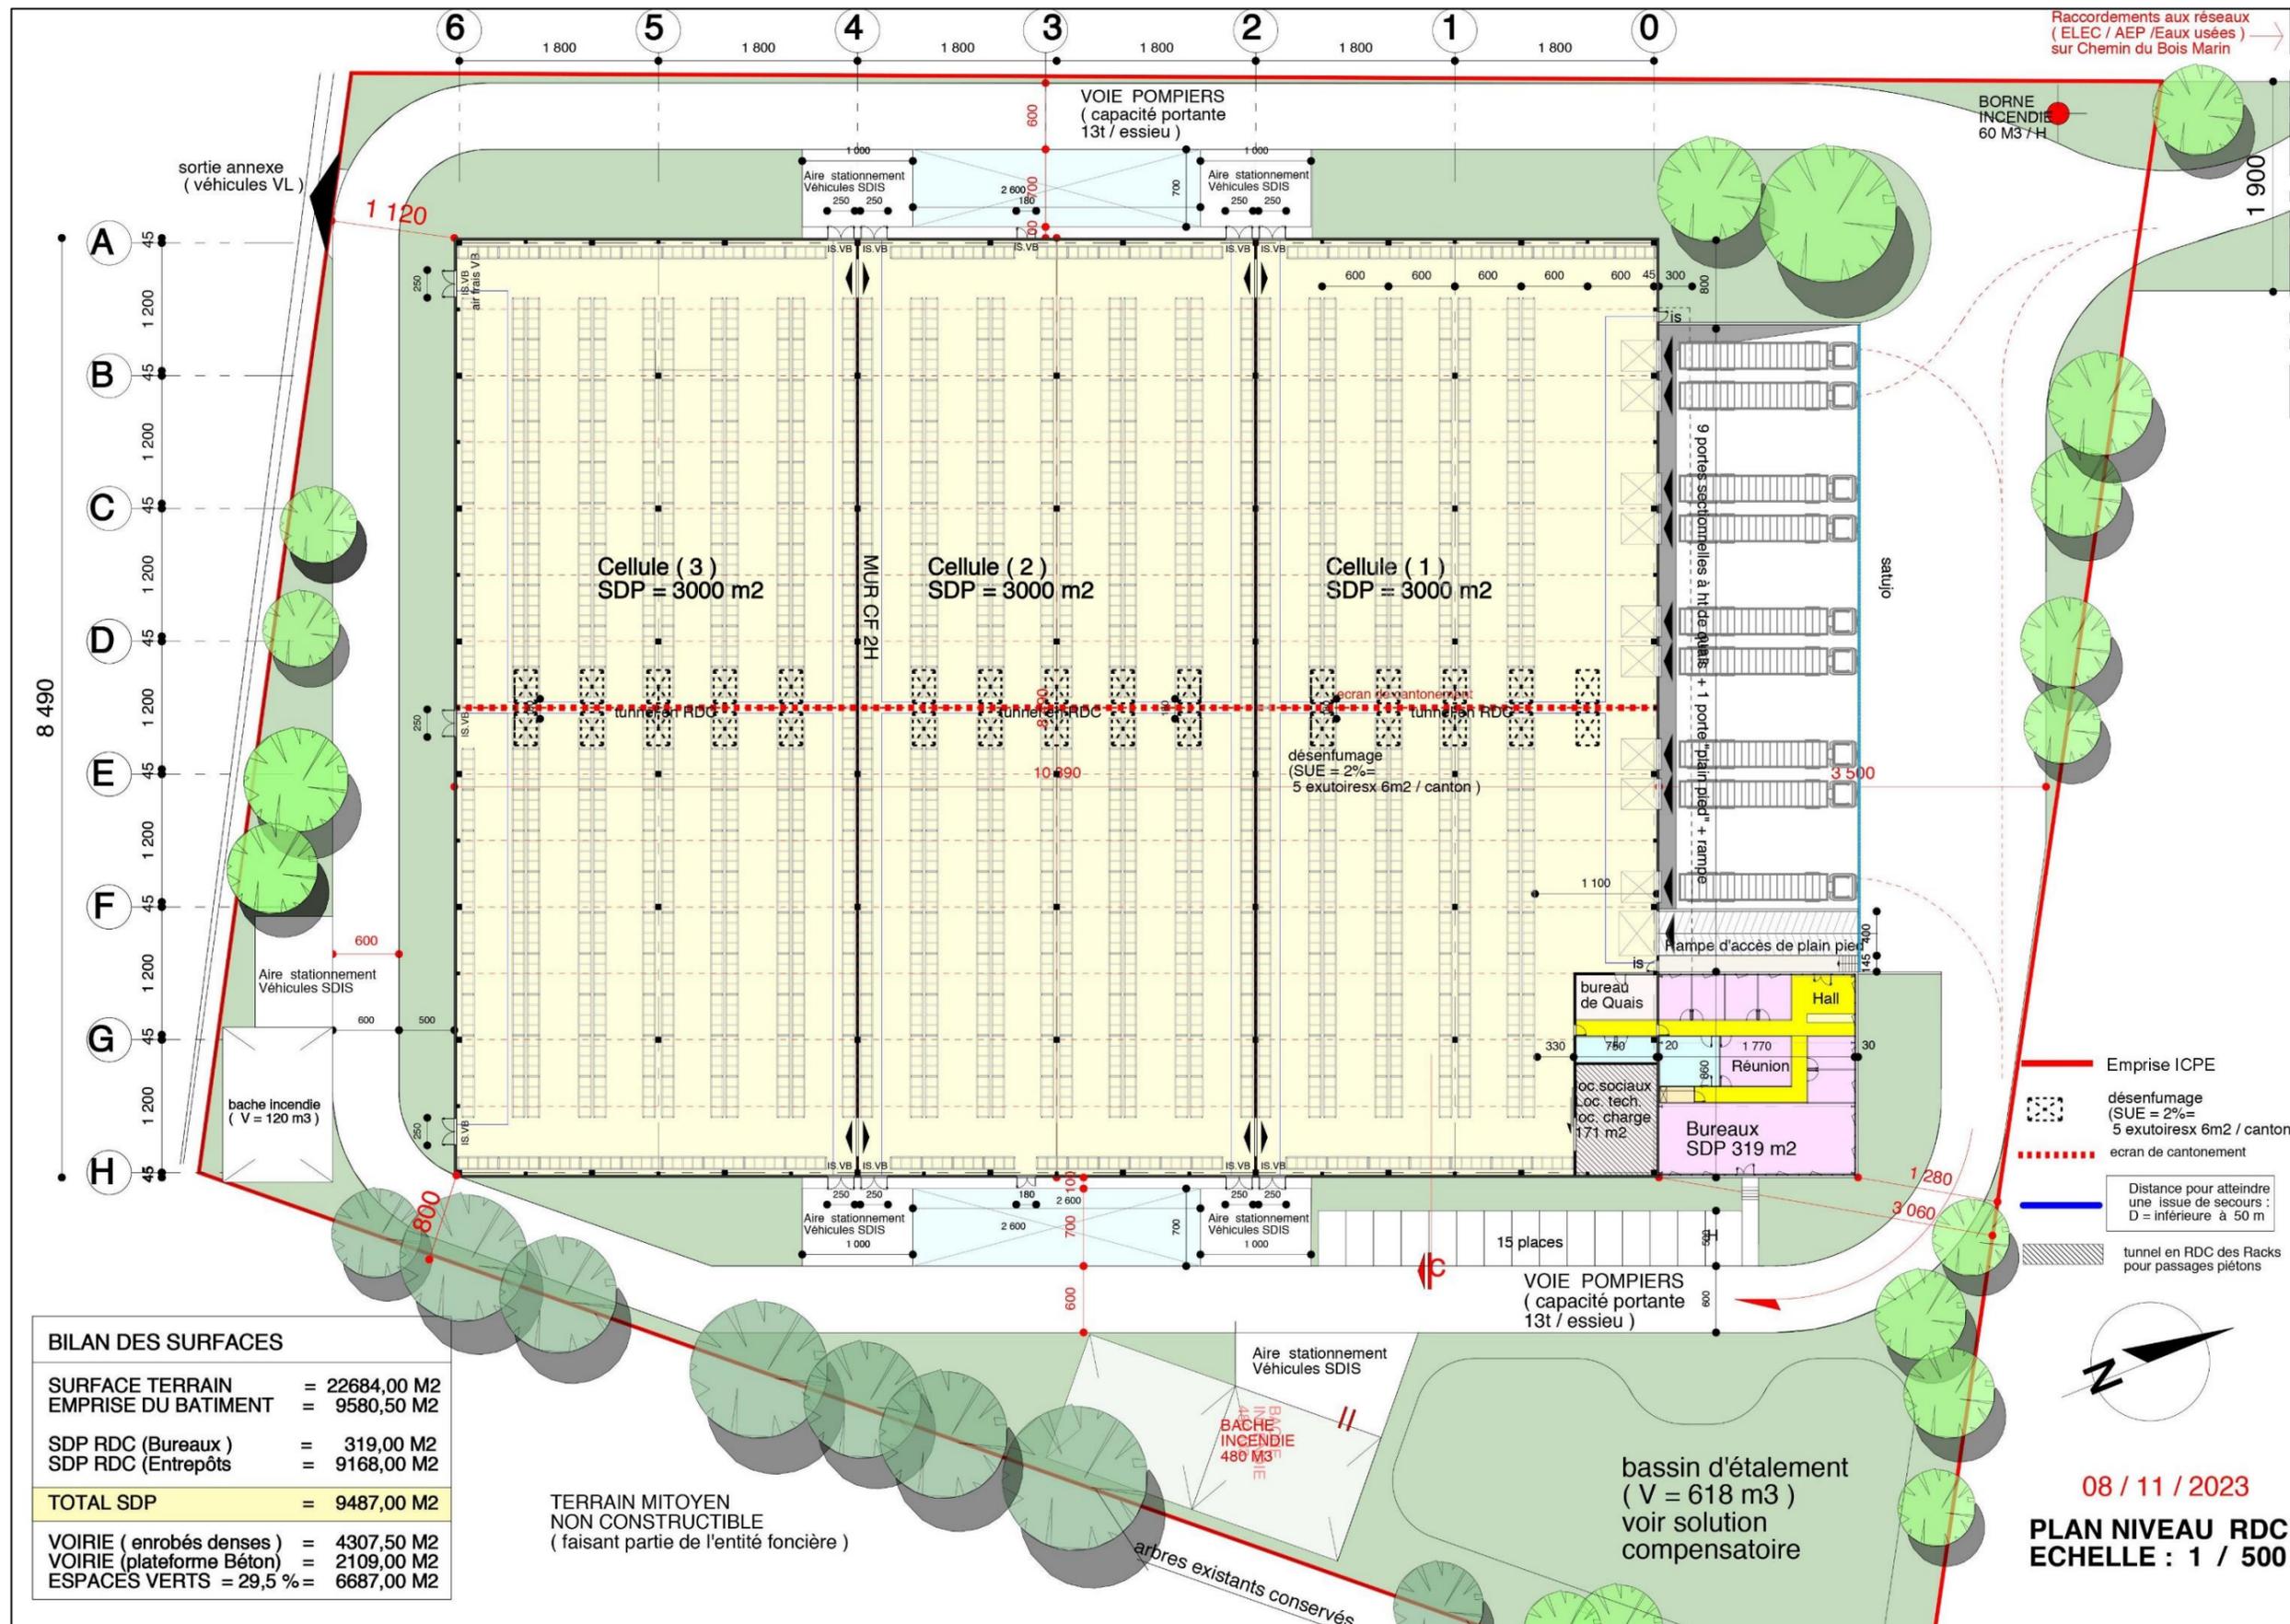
plan du bâtiment RDC (Extrait PC – H.SALADIN Architecte)
